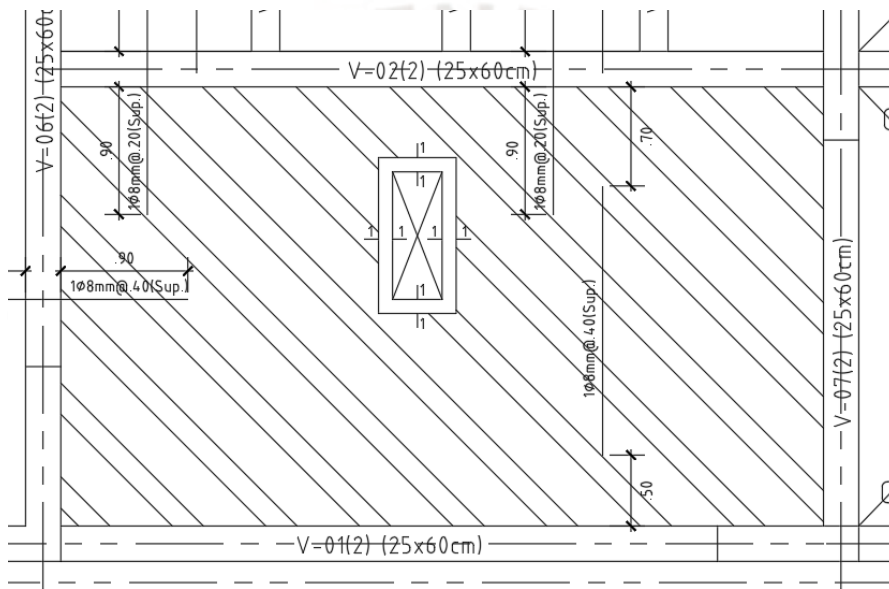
Detalle de refuerzo a flexión de losa maciza entre los ejes A-D/4-5.
